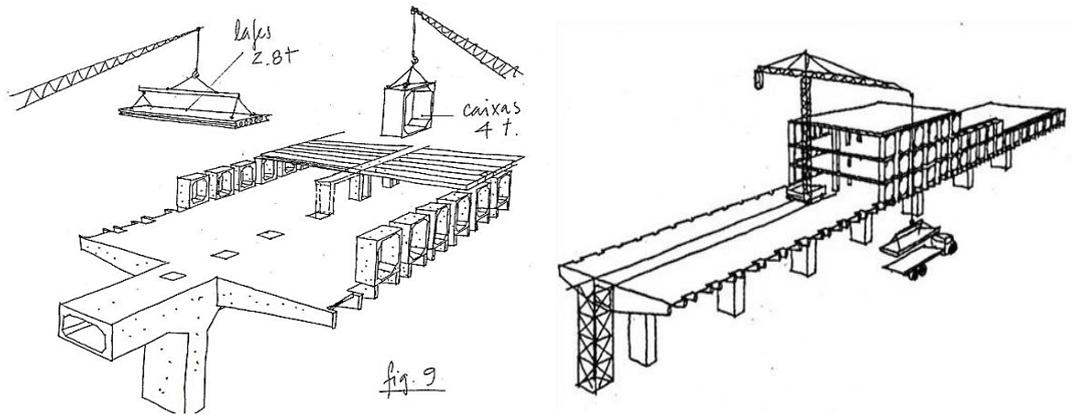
Diseño del conjunto, y esquema de piezas y montaje de cajas y losas prefabricadas
